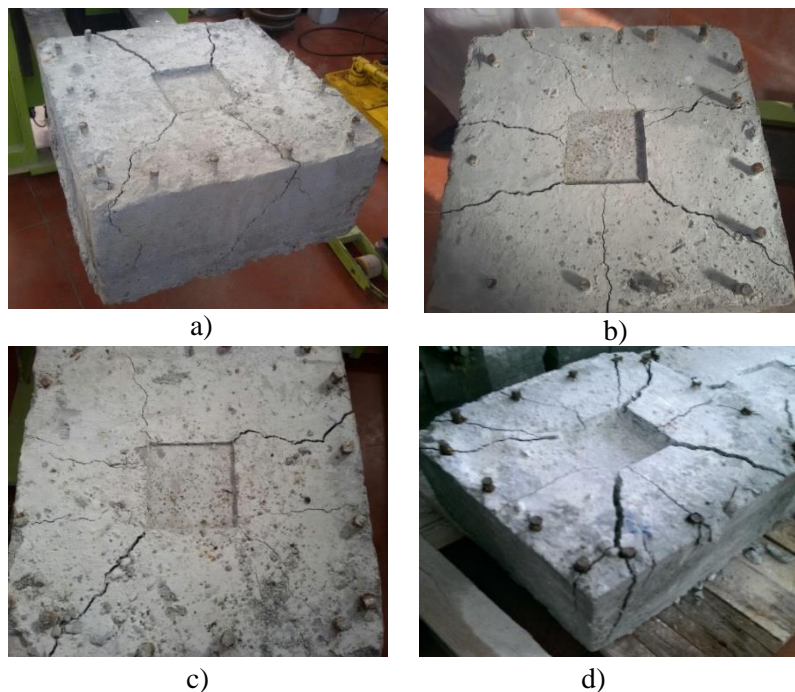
Quadro fessurativo del plinto avente altezza $h=20$ cm e con armatura: a) 10 mm; b) 12 mm; c) 14 mm; d) 16 mm.
